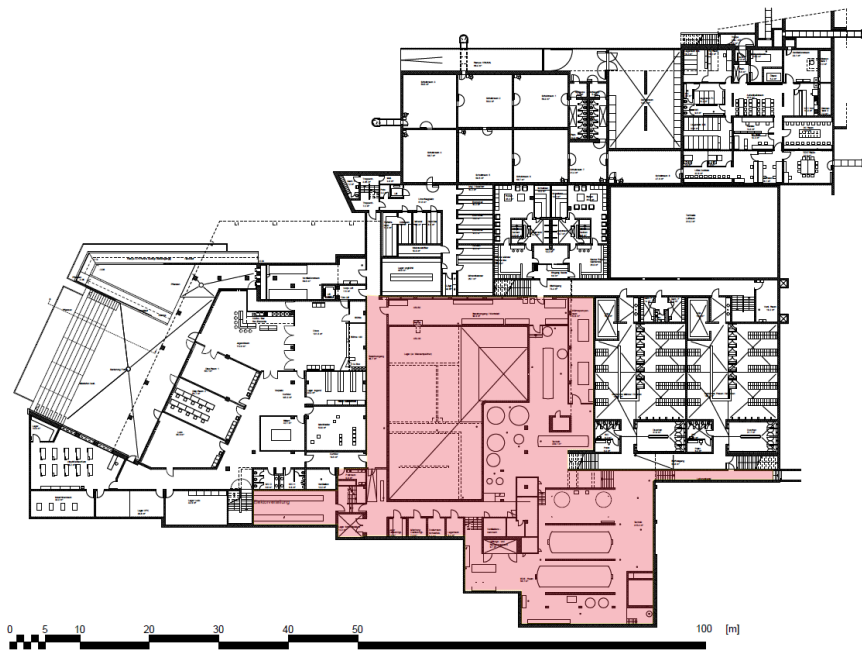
Untergeschoss (Eingriffe Bausubstanz)
